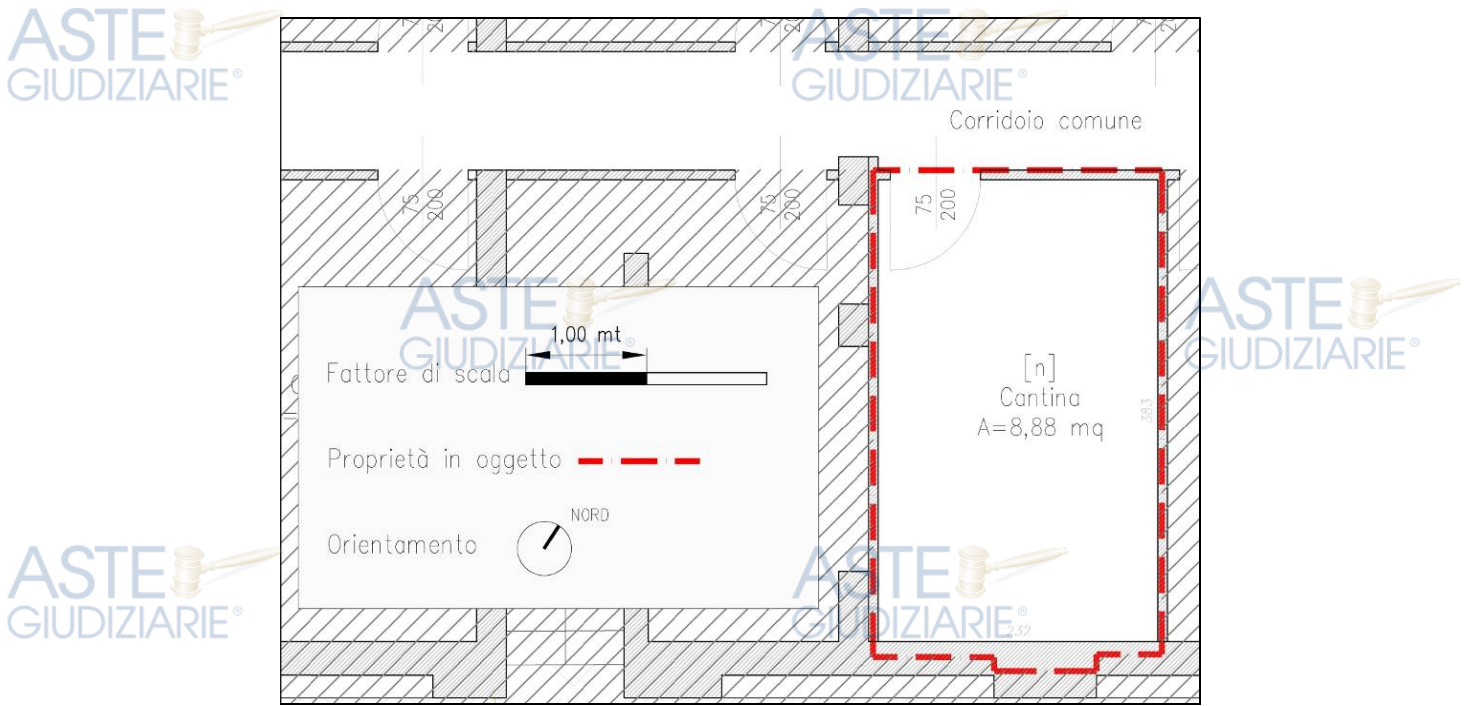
Piano interrato cantine – Pianta di rilievo cantina - Part. 336 sub. 54
